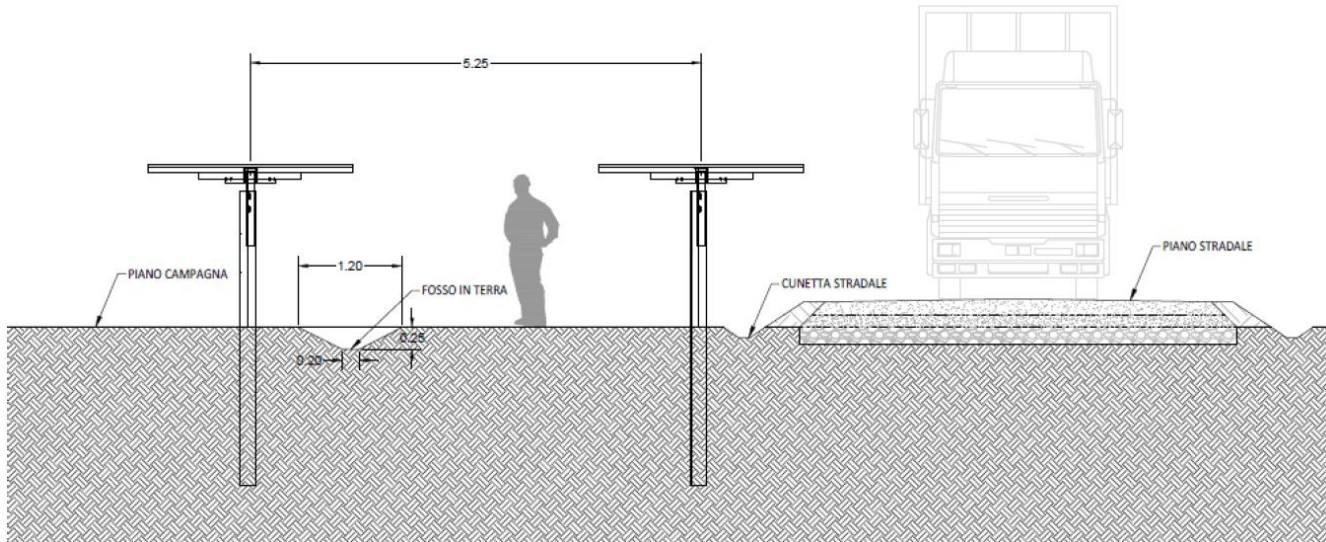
Sezione tipologica opere di regimentazione delle acque meteoriche nell'area d'impianto tra le strutture
